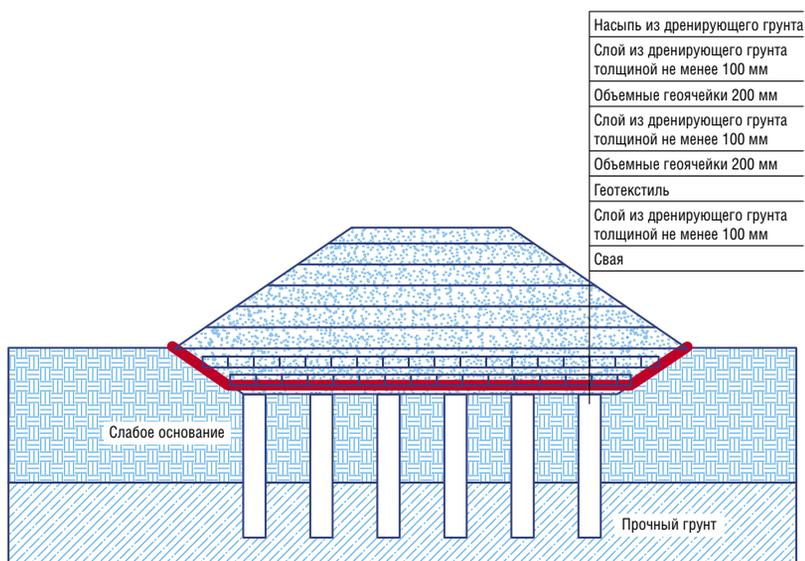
Вариант устройства насыпи на слабом основании с укладкой гибкого ростверка из объемных геоячеек «ПРУДОН-494»
